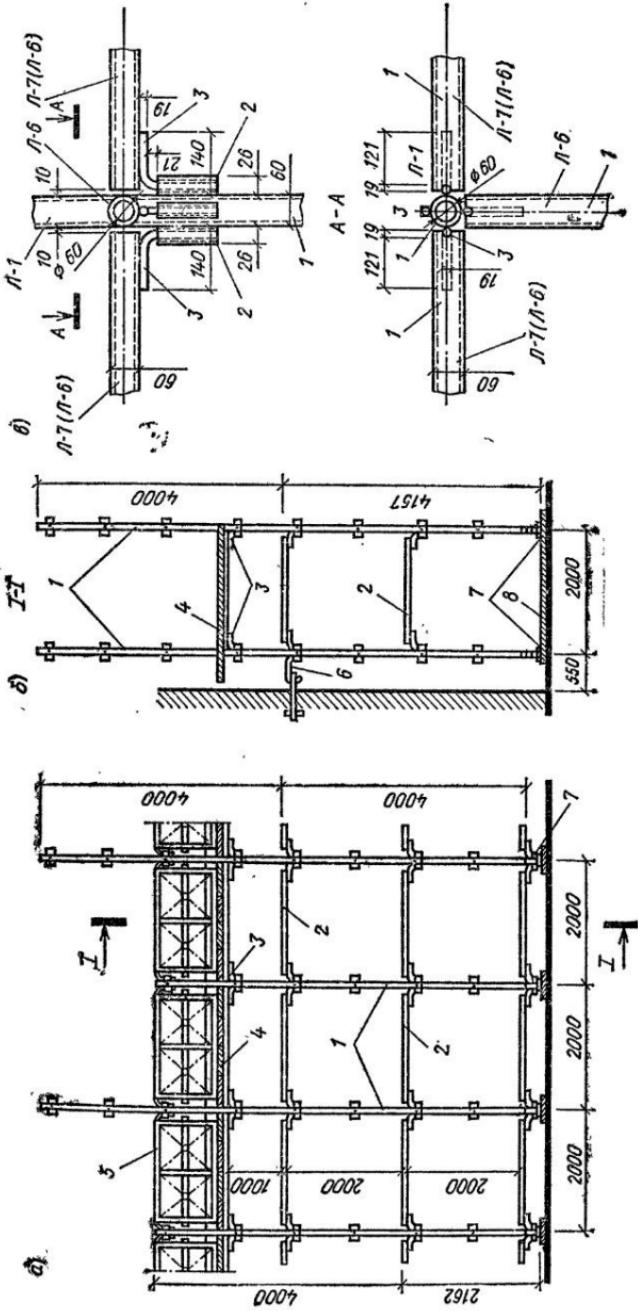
Инвентарные трубчатые леса конструкции «Промстройпроекта» и фрагмент сборочного узла
